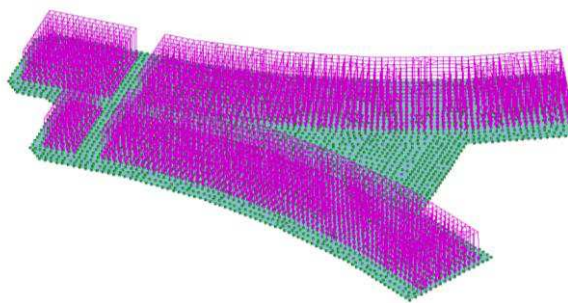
Нагрузка от перегородок, 1-27 этажи
